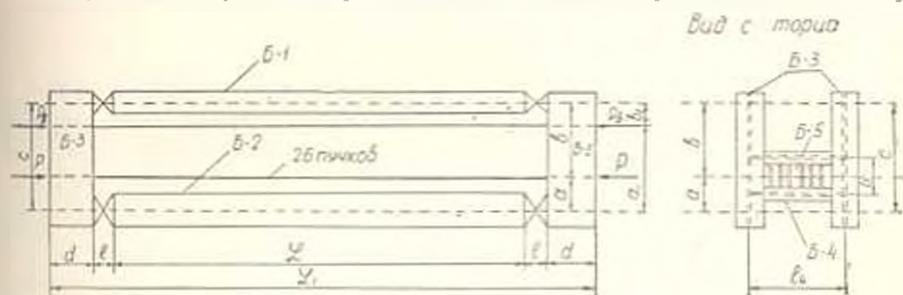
Схема металлического стенда. Б-1—балка верхней распорки; Б-2—балка нижней распорки; Б-3—опорная балка; Б-4—диафрагма; Б-5—закладные детали; P —усилие натяжения нижних арматурных пучков в балке, P_0 —усилие натяжения пучков в плите балки.
